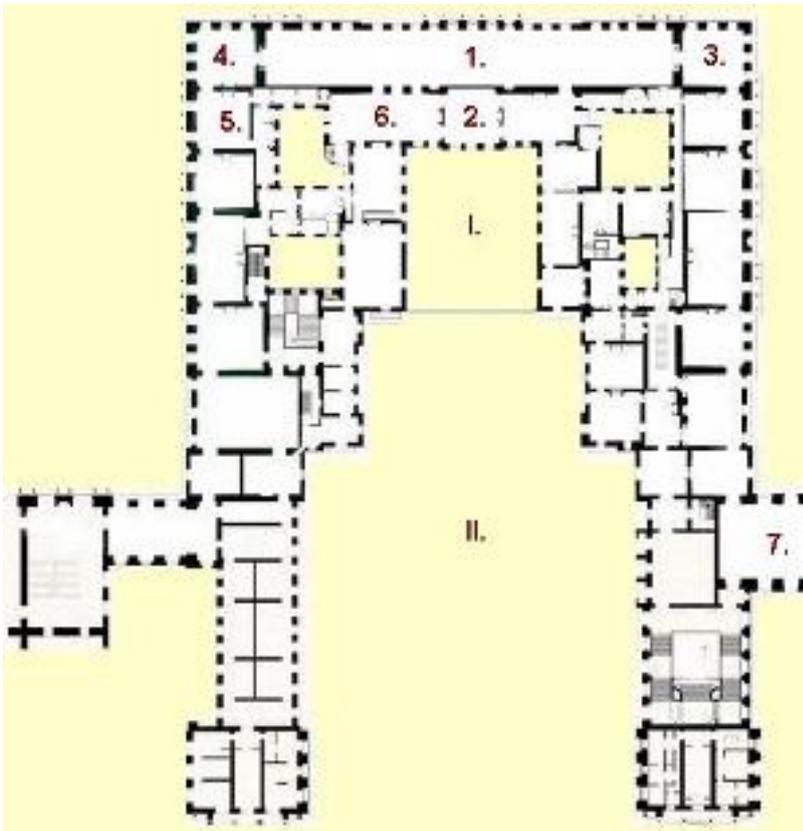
Schloss Versailles, Grundriss 1.Stock
